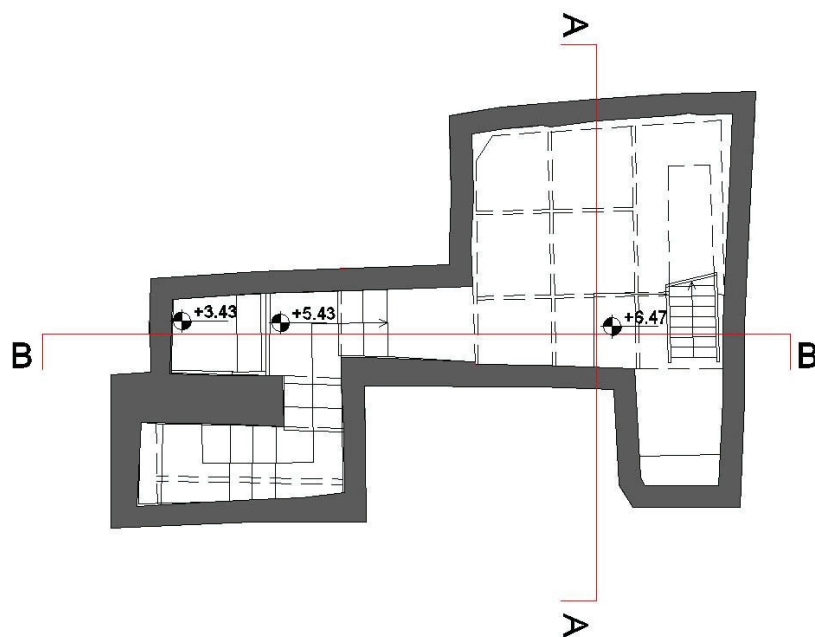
Pianta piano primo della torre campanaria - Chiesa S. Francesco, Leonessa
